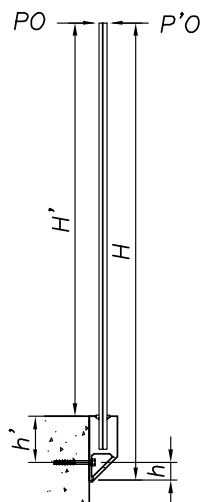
Dimensionnement des chevilles fixation nez de dalle
